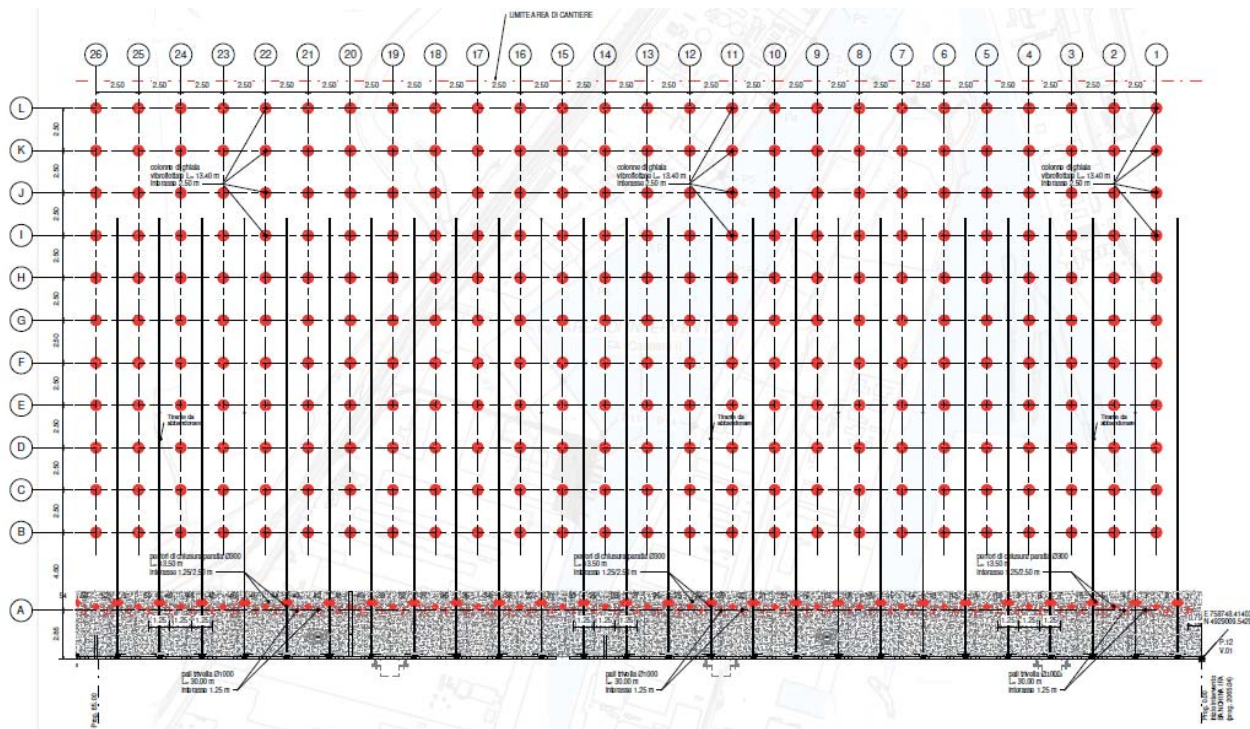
Stralcio planimetrico tracciamento colonne di ghiaia
